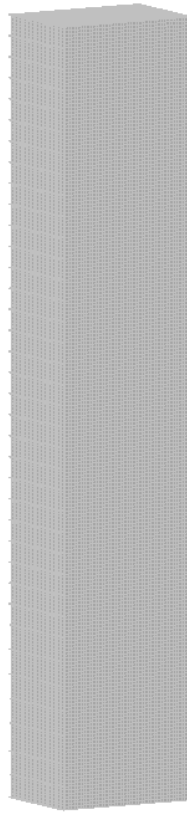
Схема ядра жесткости на всю высоту здания
